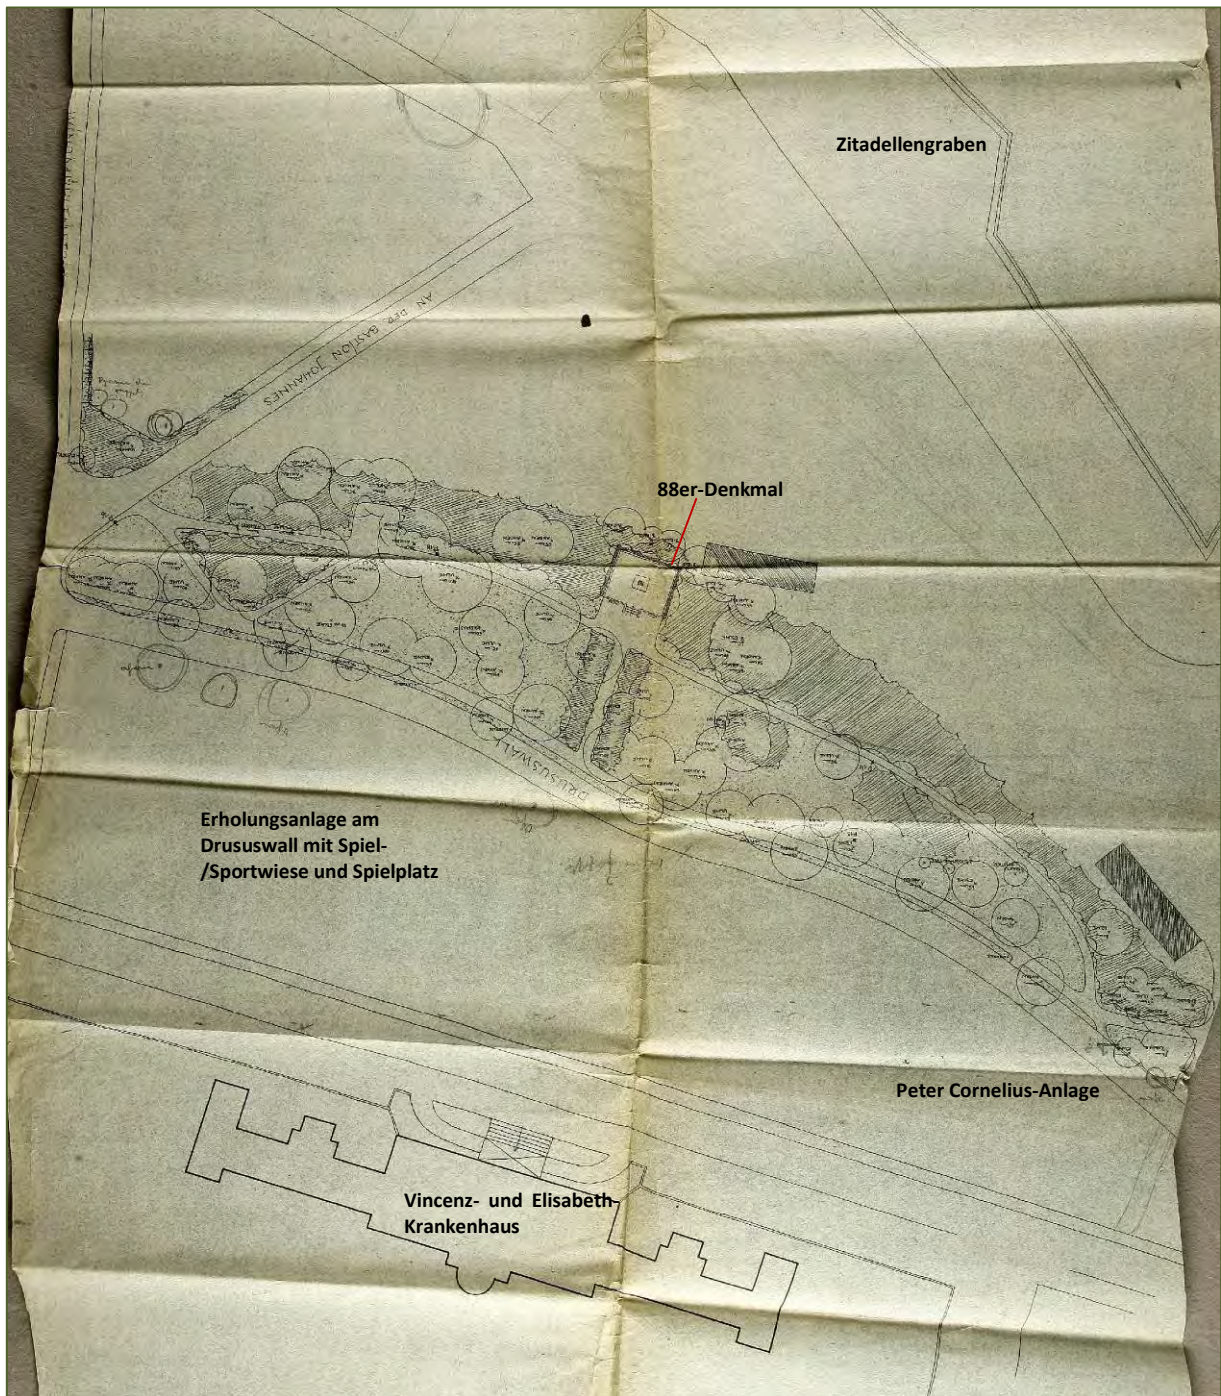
Lageplan des 88er-Denkmal am Rande des Drususwalls, um 1955
